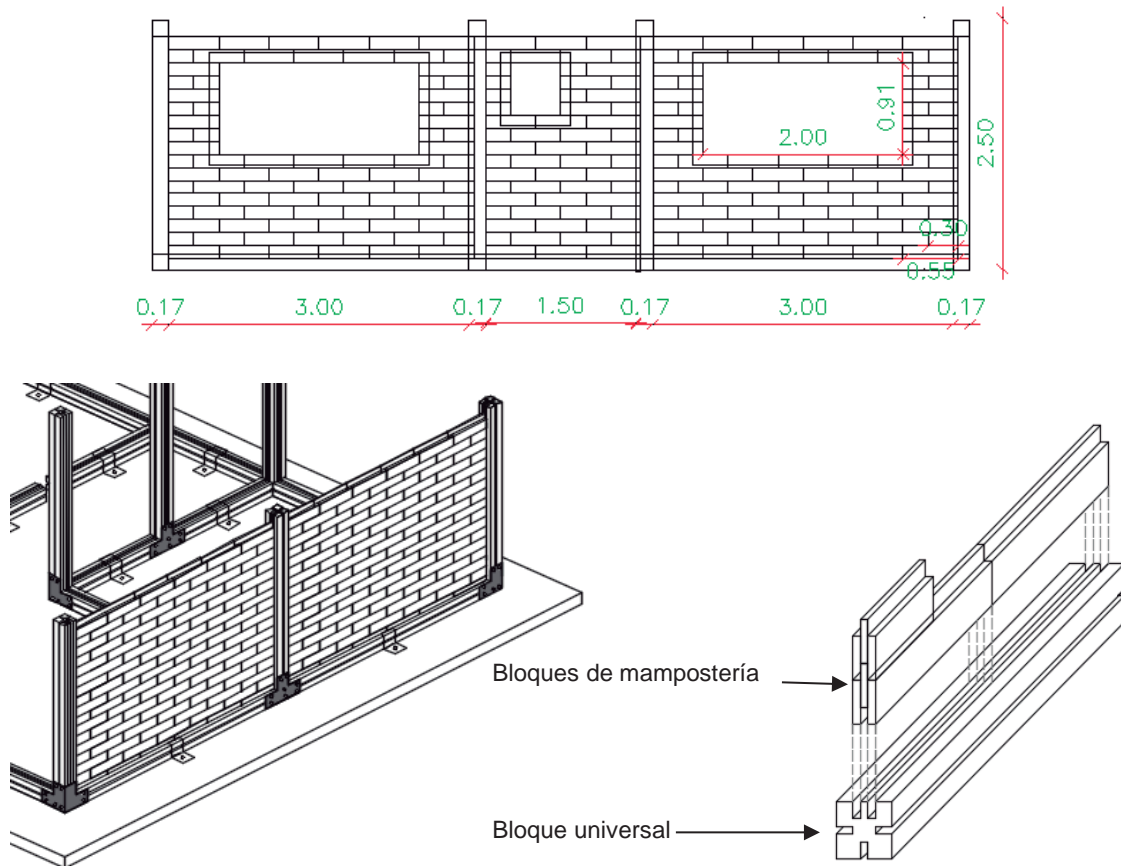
Anclaje de mampostería - AutoCAD, 2018
